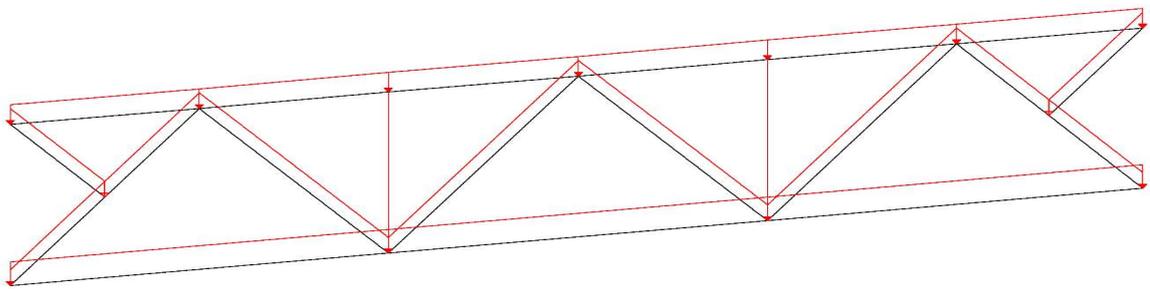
Схема приложения нагрузки собственного веса металлических конструкций
